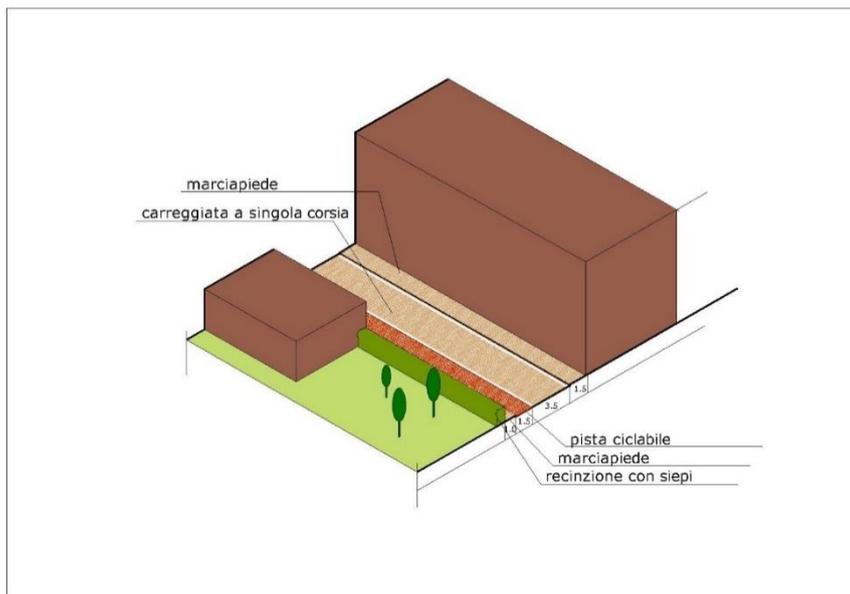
Rappresentazione schematica stato di progetto sezione 2
